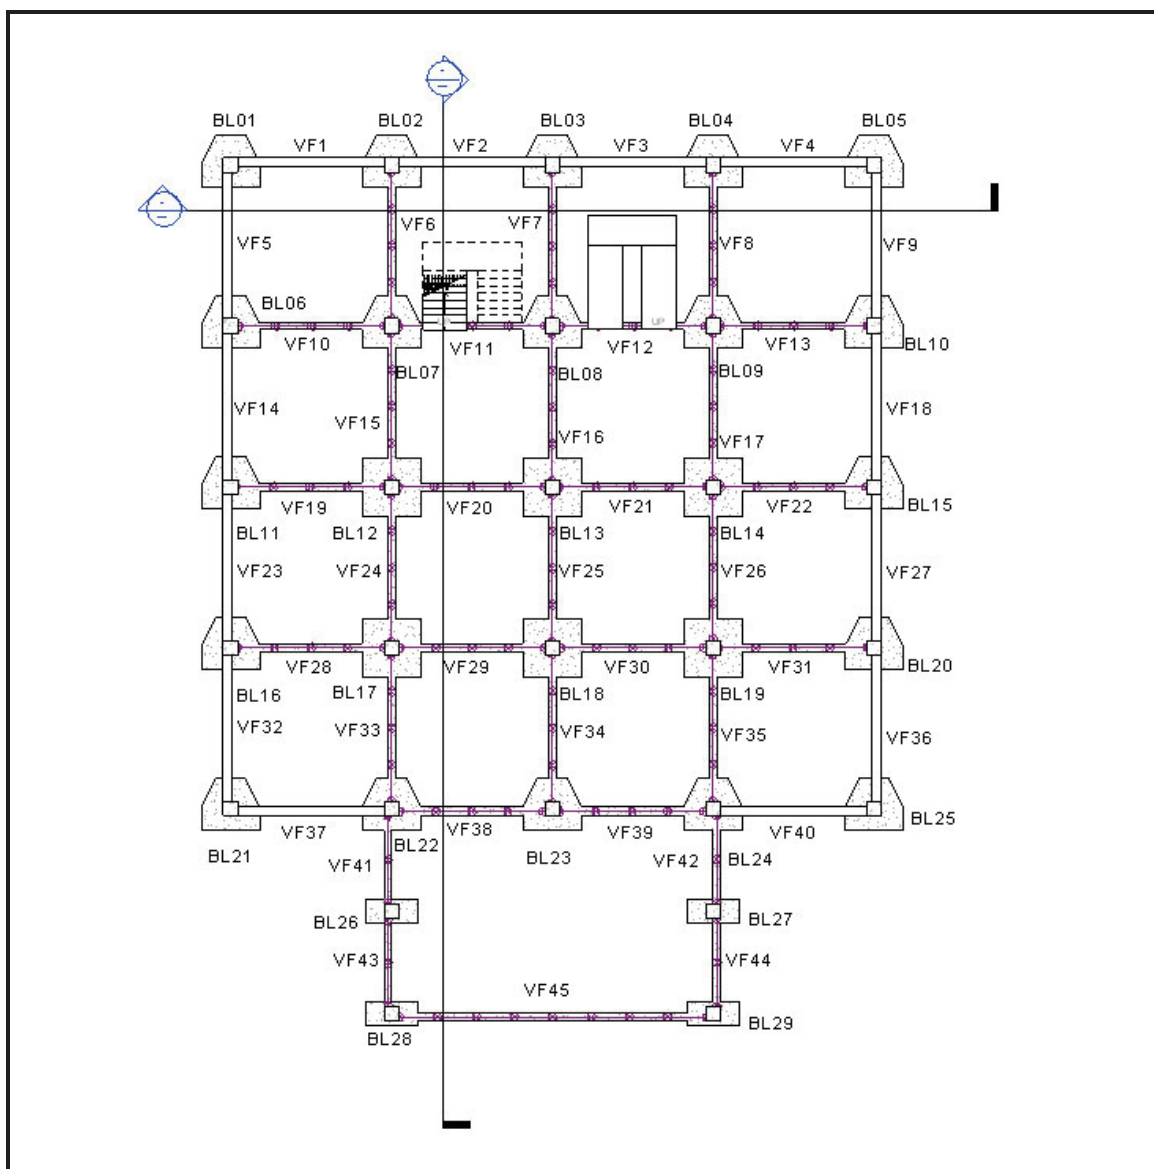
MODELO REVIT ARCHITECTURE 2011 – PAVIMENTO TÉRREO
